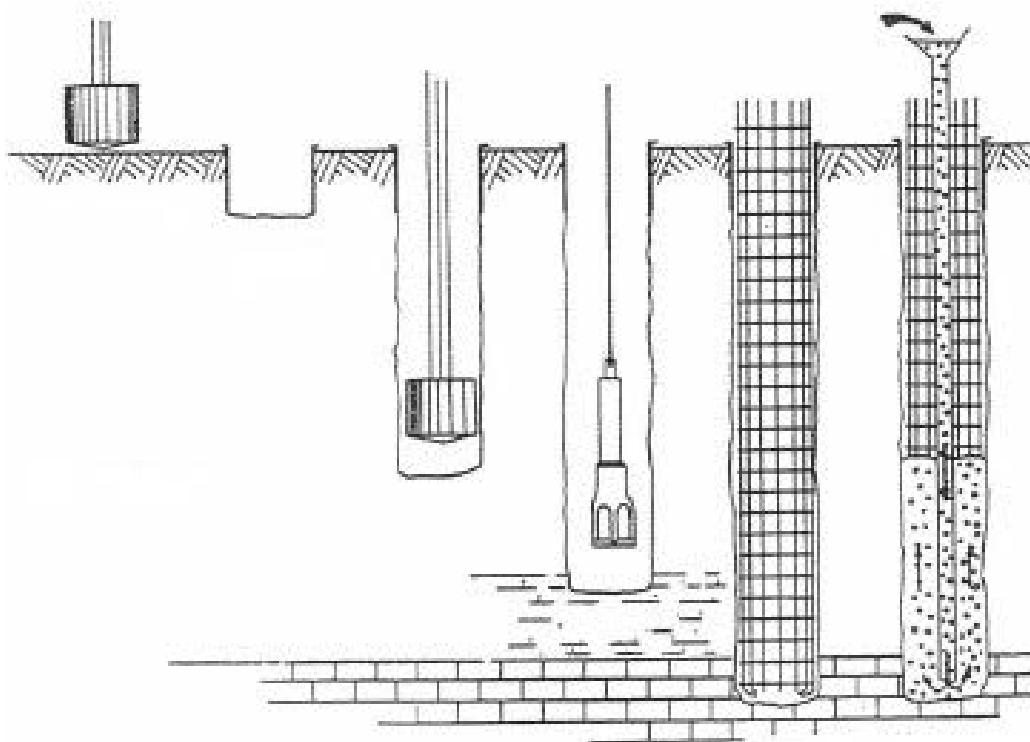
Estacas moldadas de betão armado (Reis, 1999).
